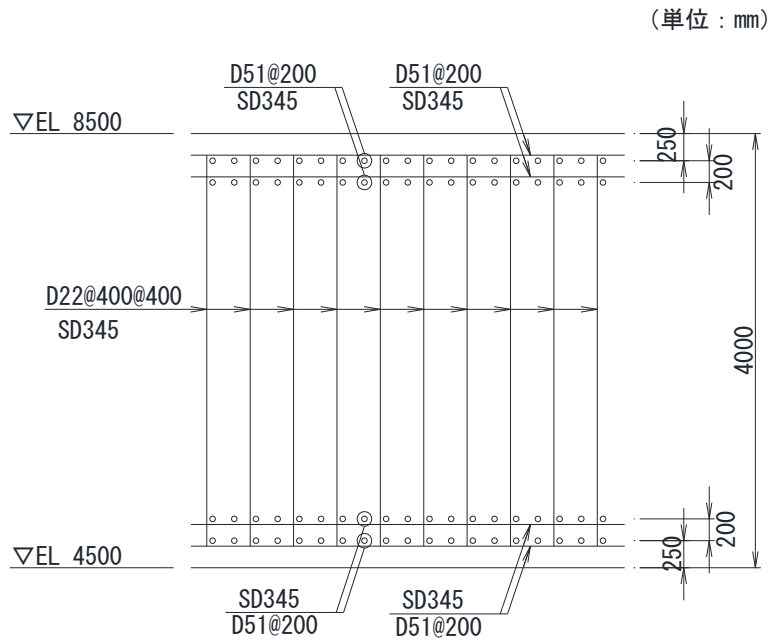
漂流物対策工基礎スラブの概略配筋図 (B-B 断面)
